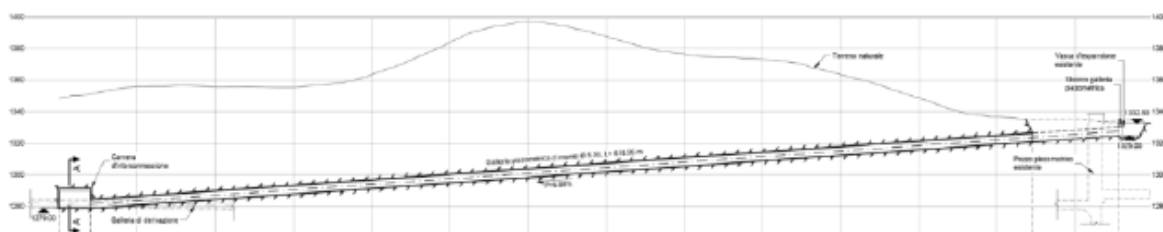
Nuovo pozzo piezometrico sulla derivazione Campotosto – profilo
